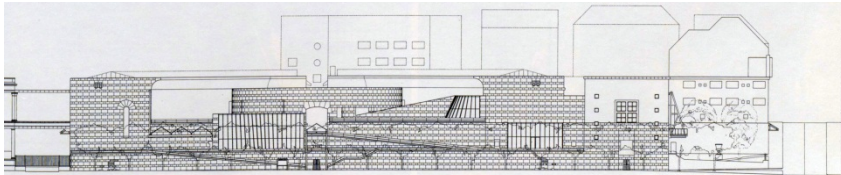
Planliche Fassadenansicht von *Konrad-Adenauer-Straße* aus gesehen;
